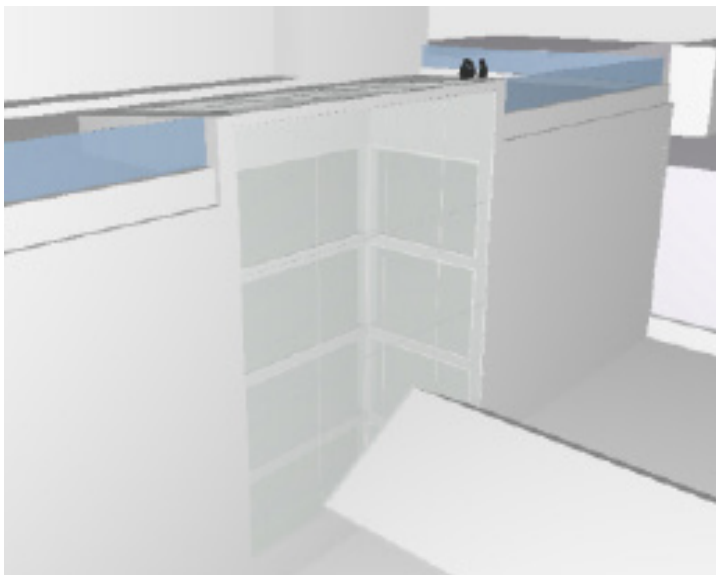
Dagsljussimuleringen undersöker hur ett atrium vid den östra fasaden bidrar till att uppfylla dagsljuskraven på våning ett till sex i byggnaden som planförslaget medger.
